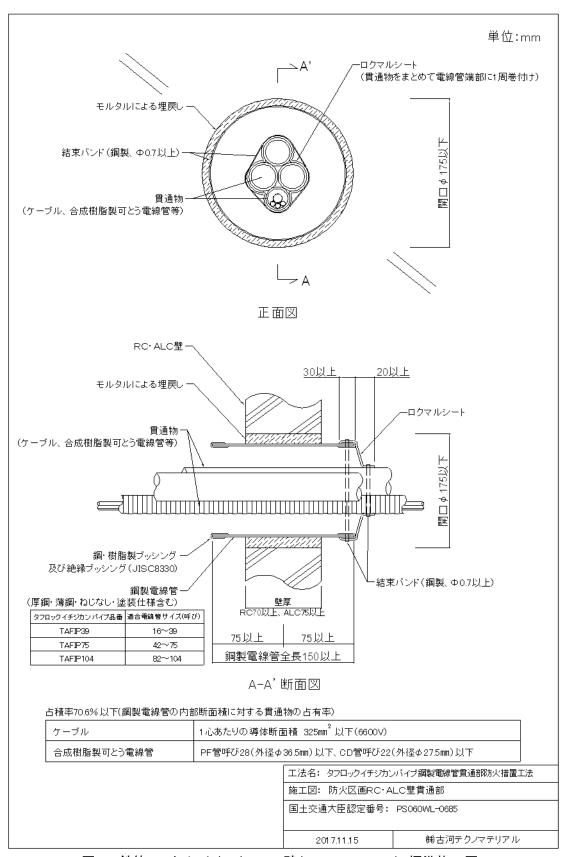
鉄筋コンクリート(RC)・ALC 壁(PS060WL-0685) 標準施工図
